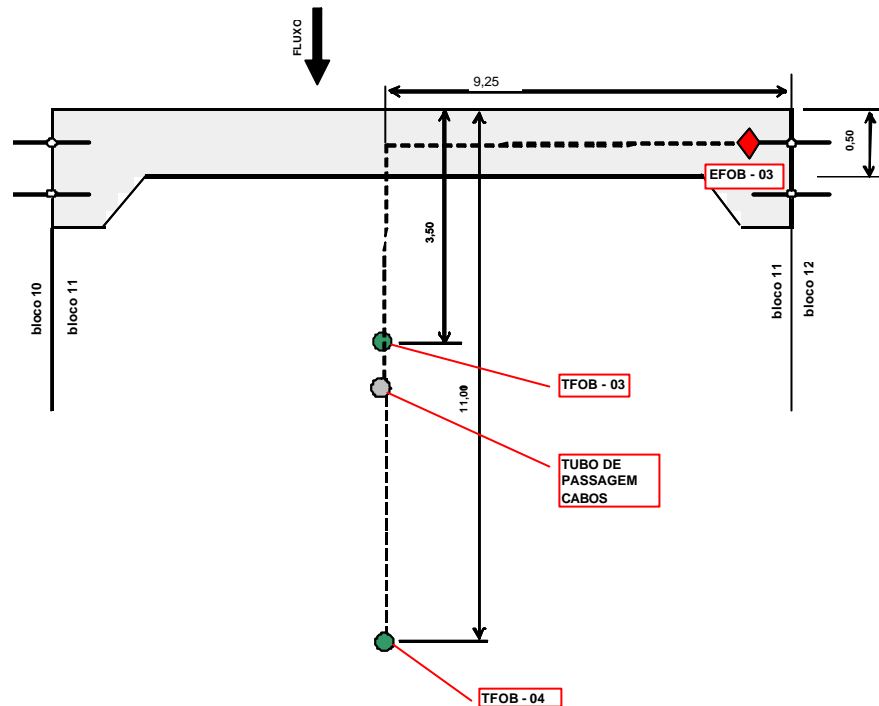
CROQUI EM PLANTA DA INSTALAÇÃO DO TFOB E EFOB EL 690,00
